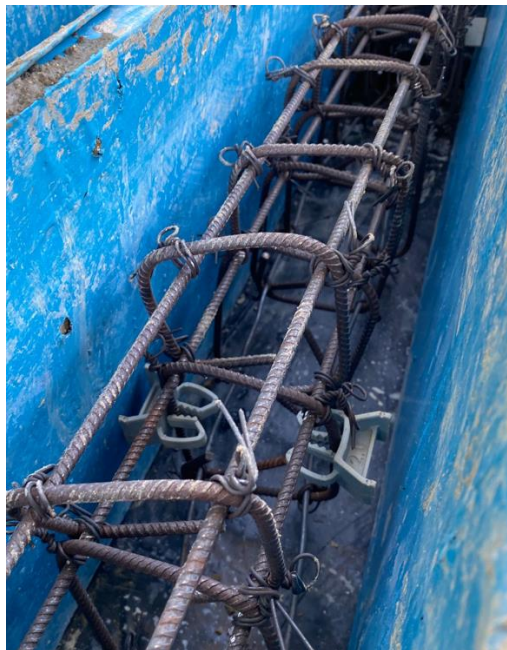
Vista lateral del acero introducido en el encofrado con colocación de separadores.
